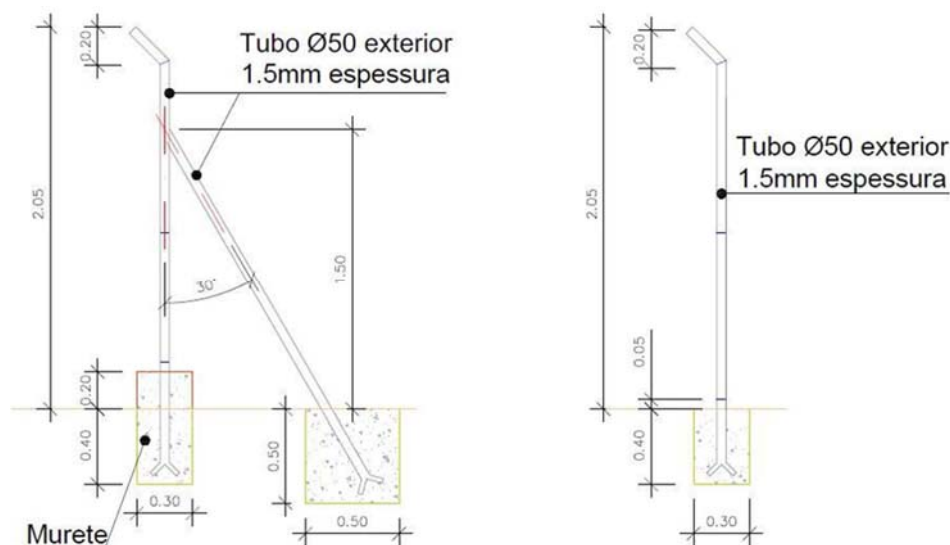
Geometria dos postes e fundações (com e sem contraventamento transversal)
